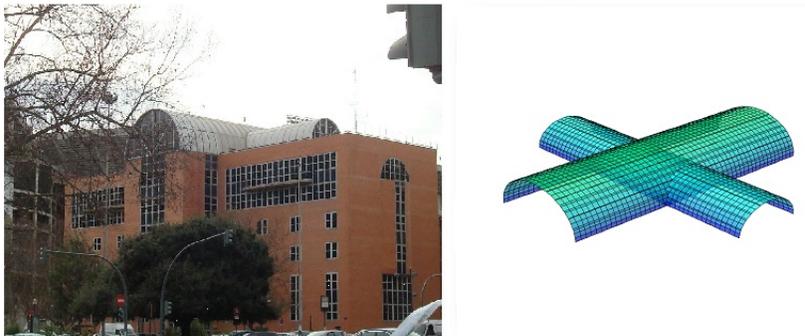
Nuevo ayuntamiento de Valencia. Dos superficies cilíndricas que intersectan constituyen la cubierta del edificio.
